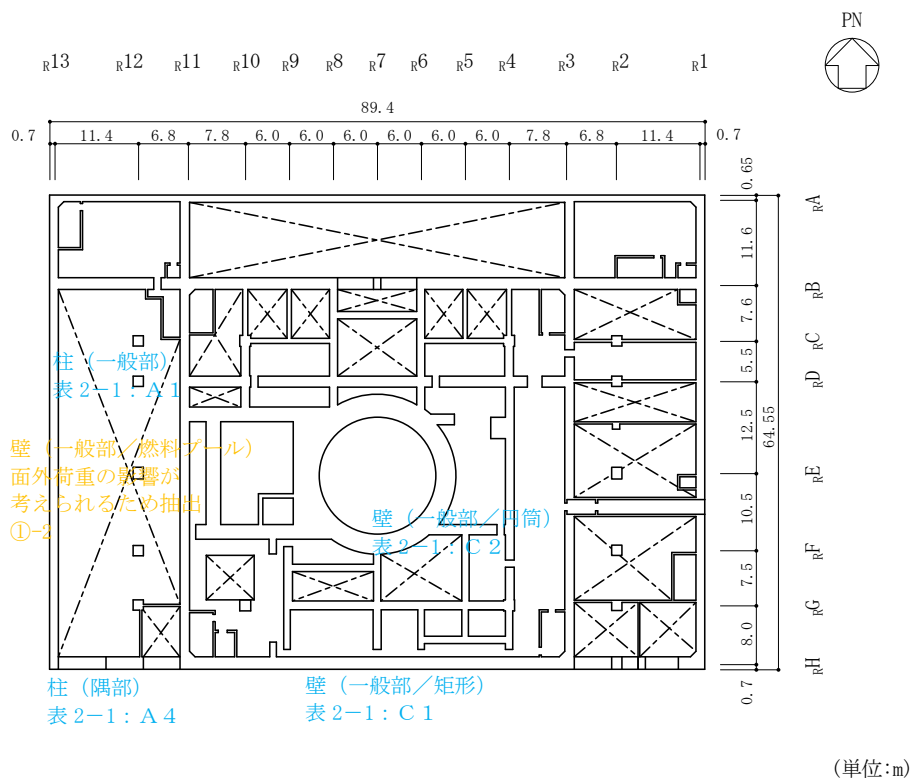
(5) 原子炉建物の概略平面図 (EL 30.5m)
